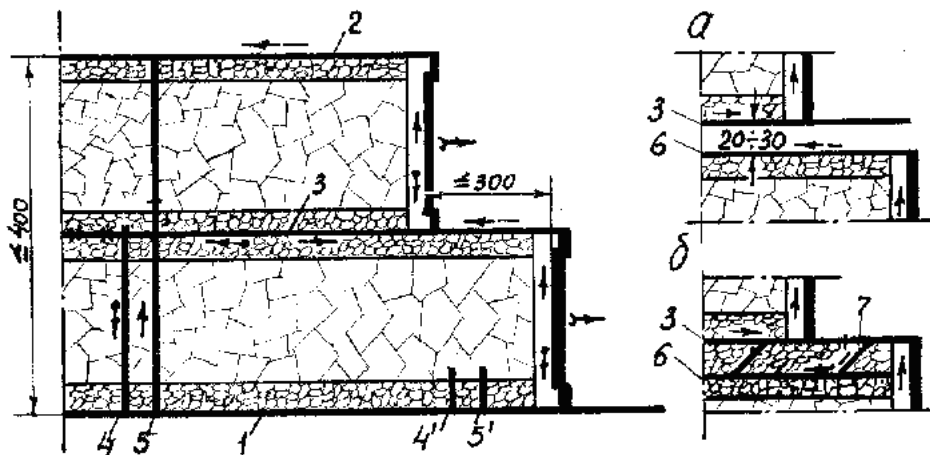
Сплошная система разработки с разделением этажа на подэтажи:
